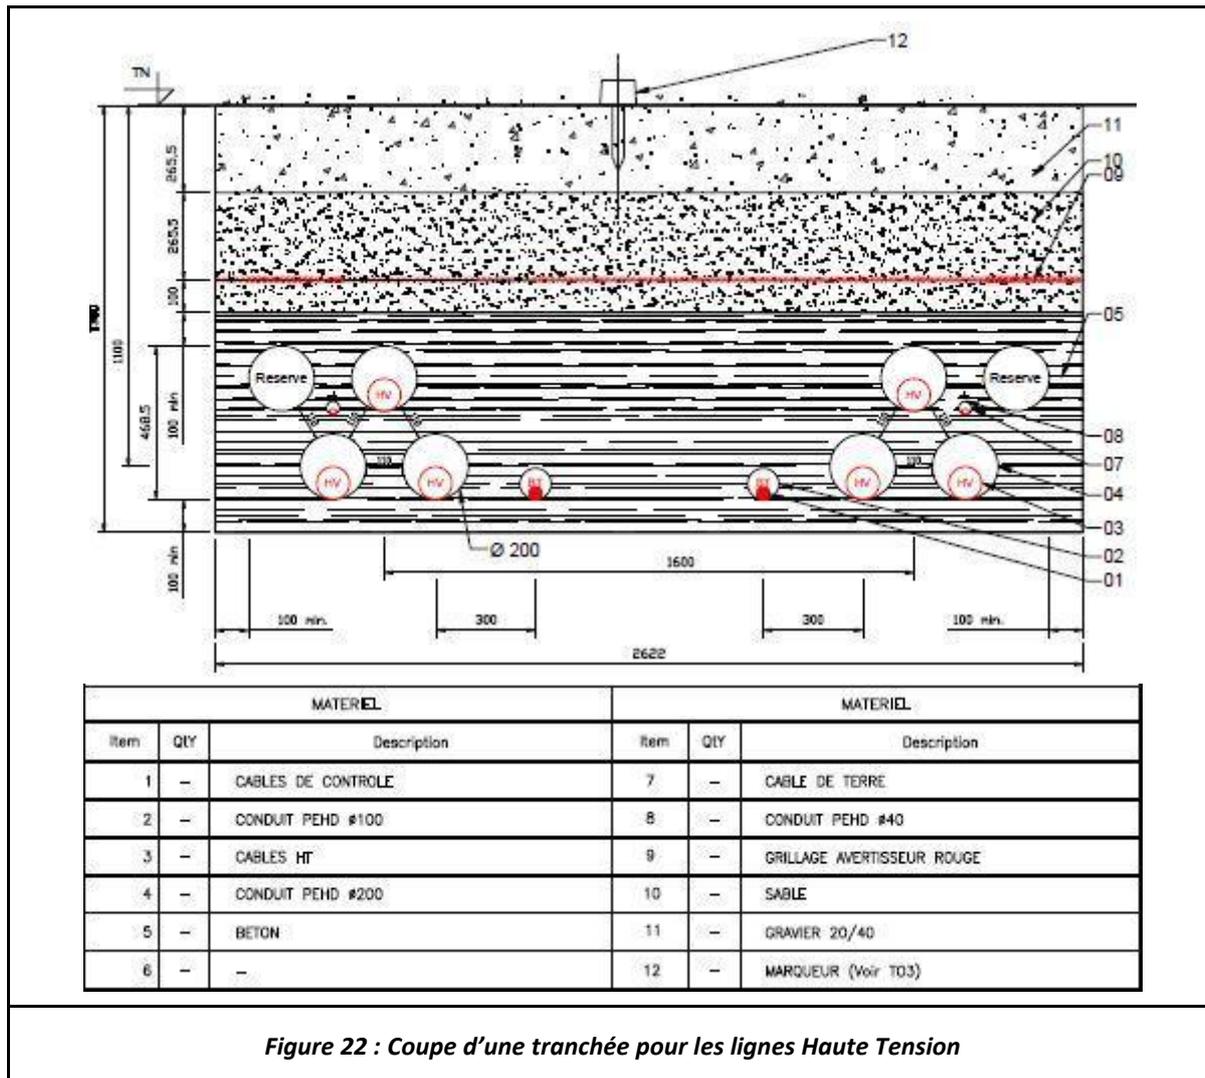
Coupe d'une tranchée pour les lignes Haute Tension
